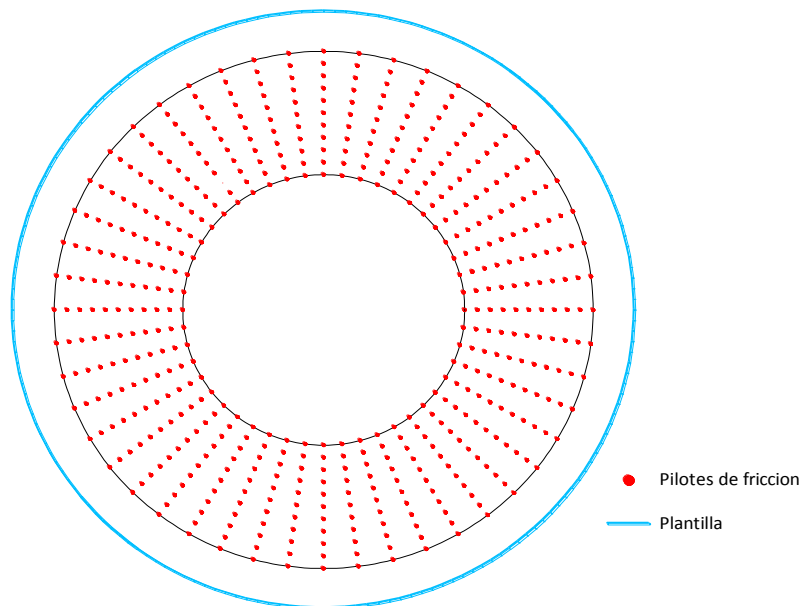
Vista en planta de la distribución de pilotes para la cimentación
